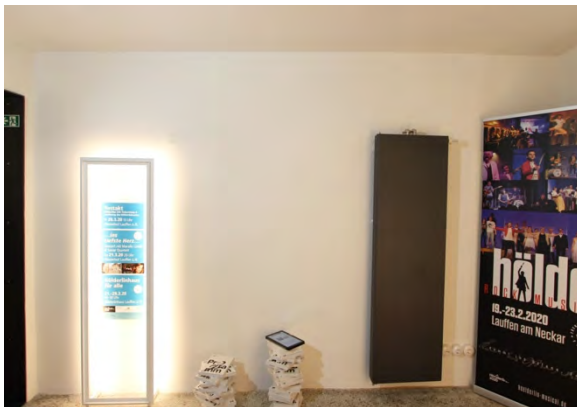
Raum 1.07/1.08, Wand b; Endzustand.
